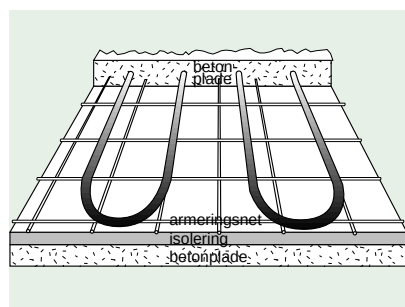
Eksempel på gulvvarmekonstruktion i betongulv.
